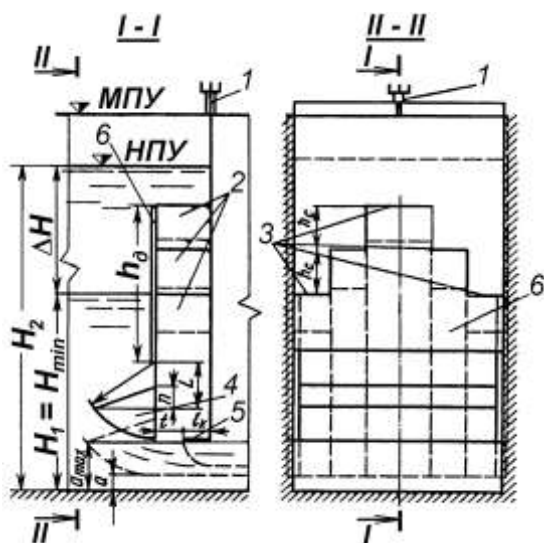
Конструкция стабилизатора расхода воды типа «Телескопический ступенчатый секционный коробчатый щит»: 1 – винтовой подъемник; 2 – коробчатый секционный аавтор рамы; 3 – водосливная часть затвора; 4 – криволинейный козырек; 5 – горизонтальный козырек; 6 – секции.
